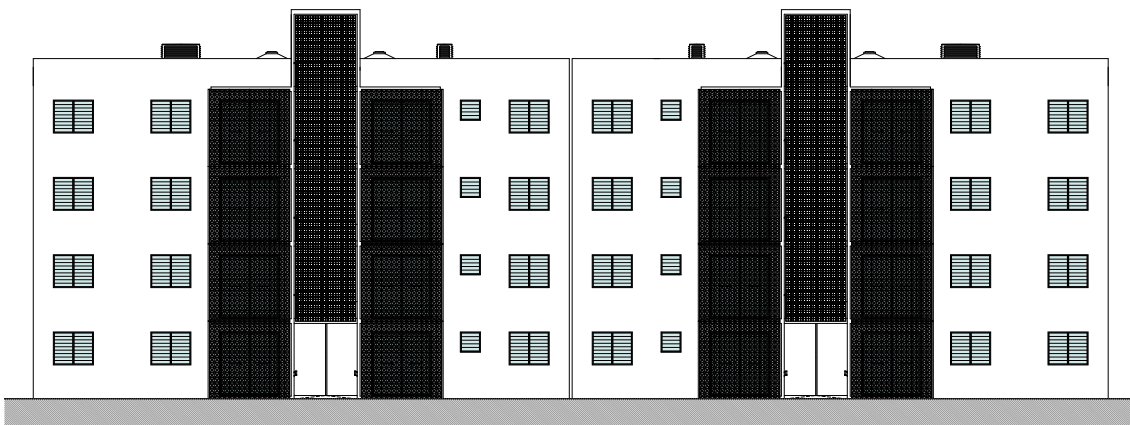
Elevación Sur, La Barquita, Santo Domingo.
